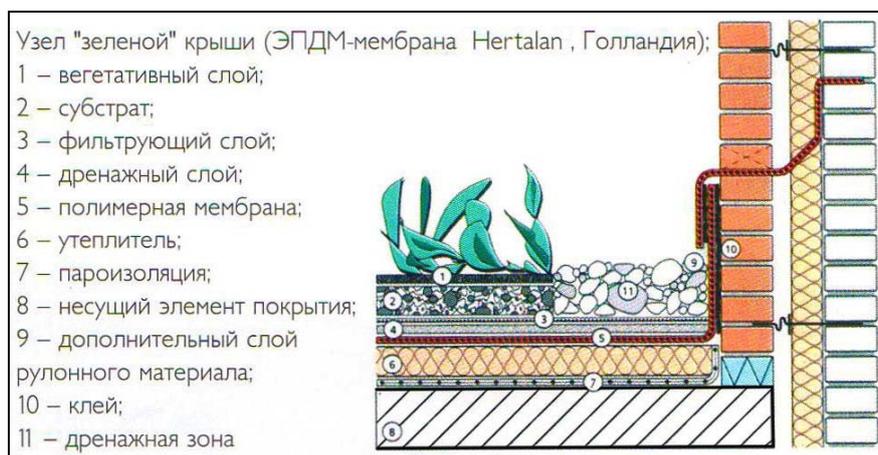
Совмещенная кровля с прямым расположением слоев, водоизоляцией из полимерной мембраны и озеленением
